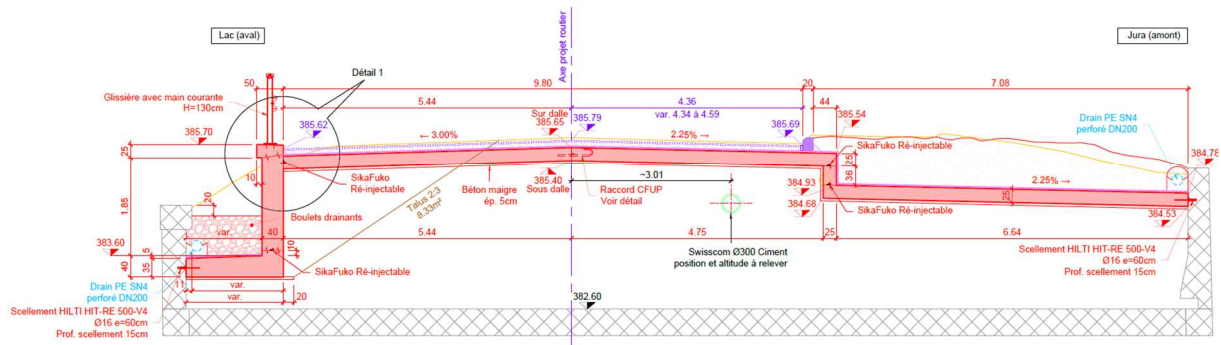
Coupe transversale sur le pont sur la Dullive
